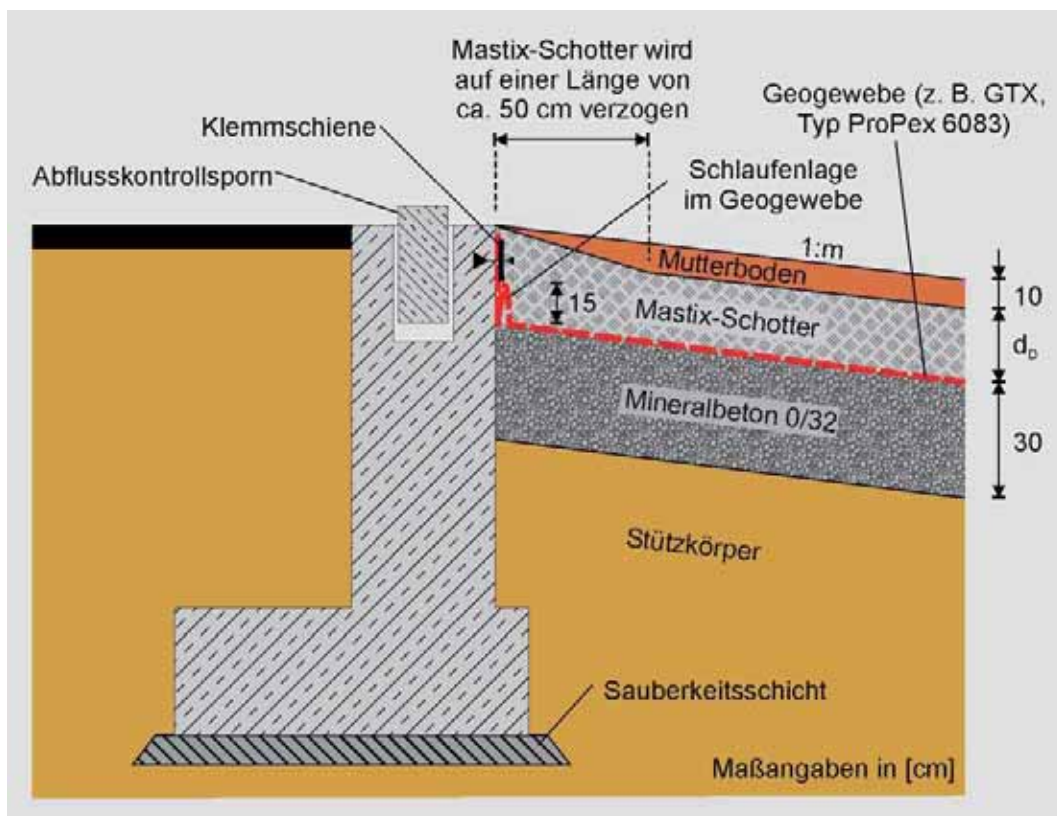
Ausführung des Mastix-Schotter-Deckwerks an der Überlaufschwelle (Detailansicht).
